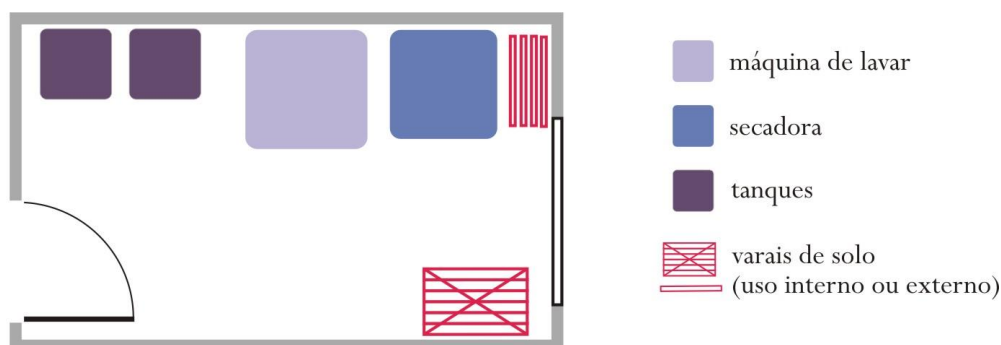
Edifício Central Place - planta baixa da lavanderia coletiva
